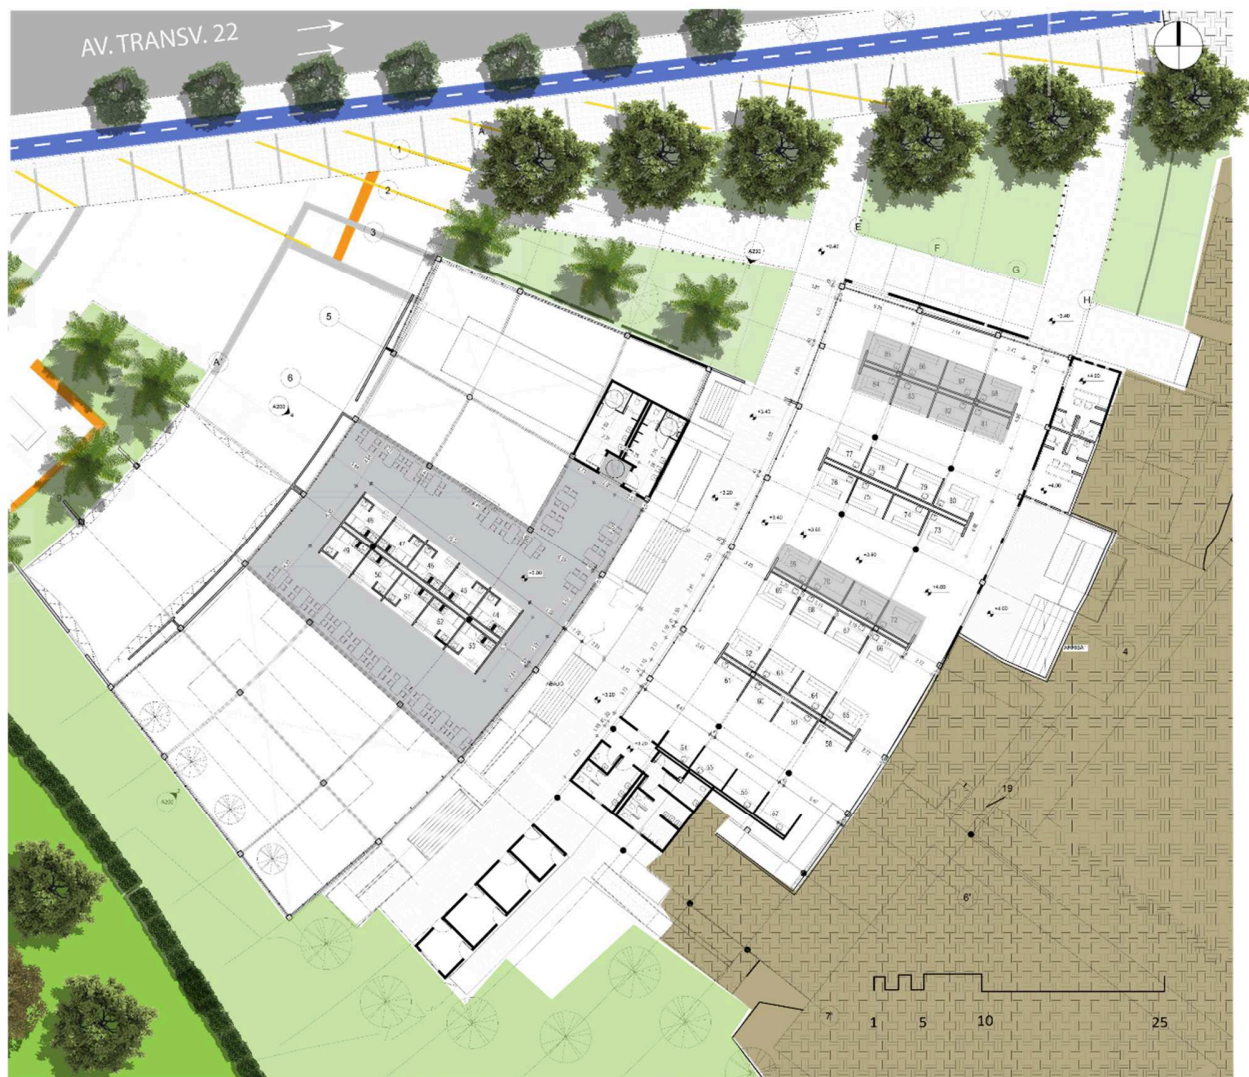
Planta arquitectónica Nivel 2 +4.00 y mezanine Nivel +5.00
